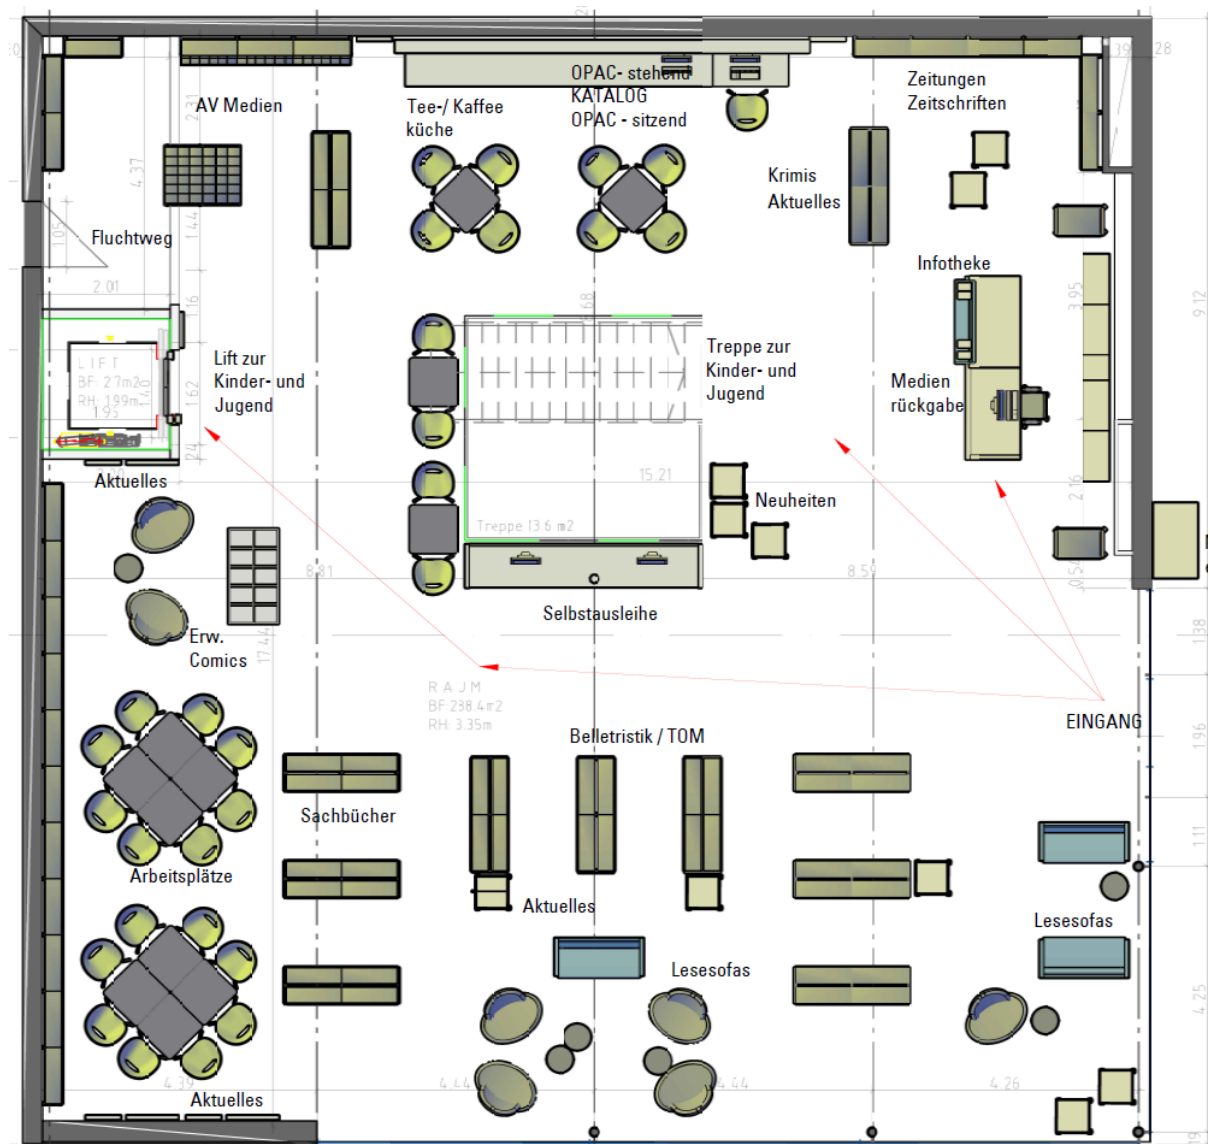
Grundriss Erdgeschoss Bernstrasse 72 – mit möglicher Einteilung und Möblierung (Vorprojekt)
